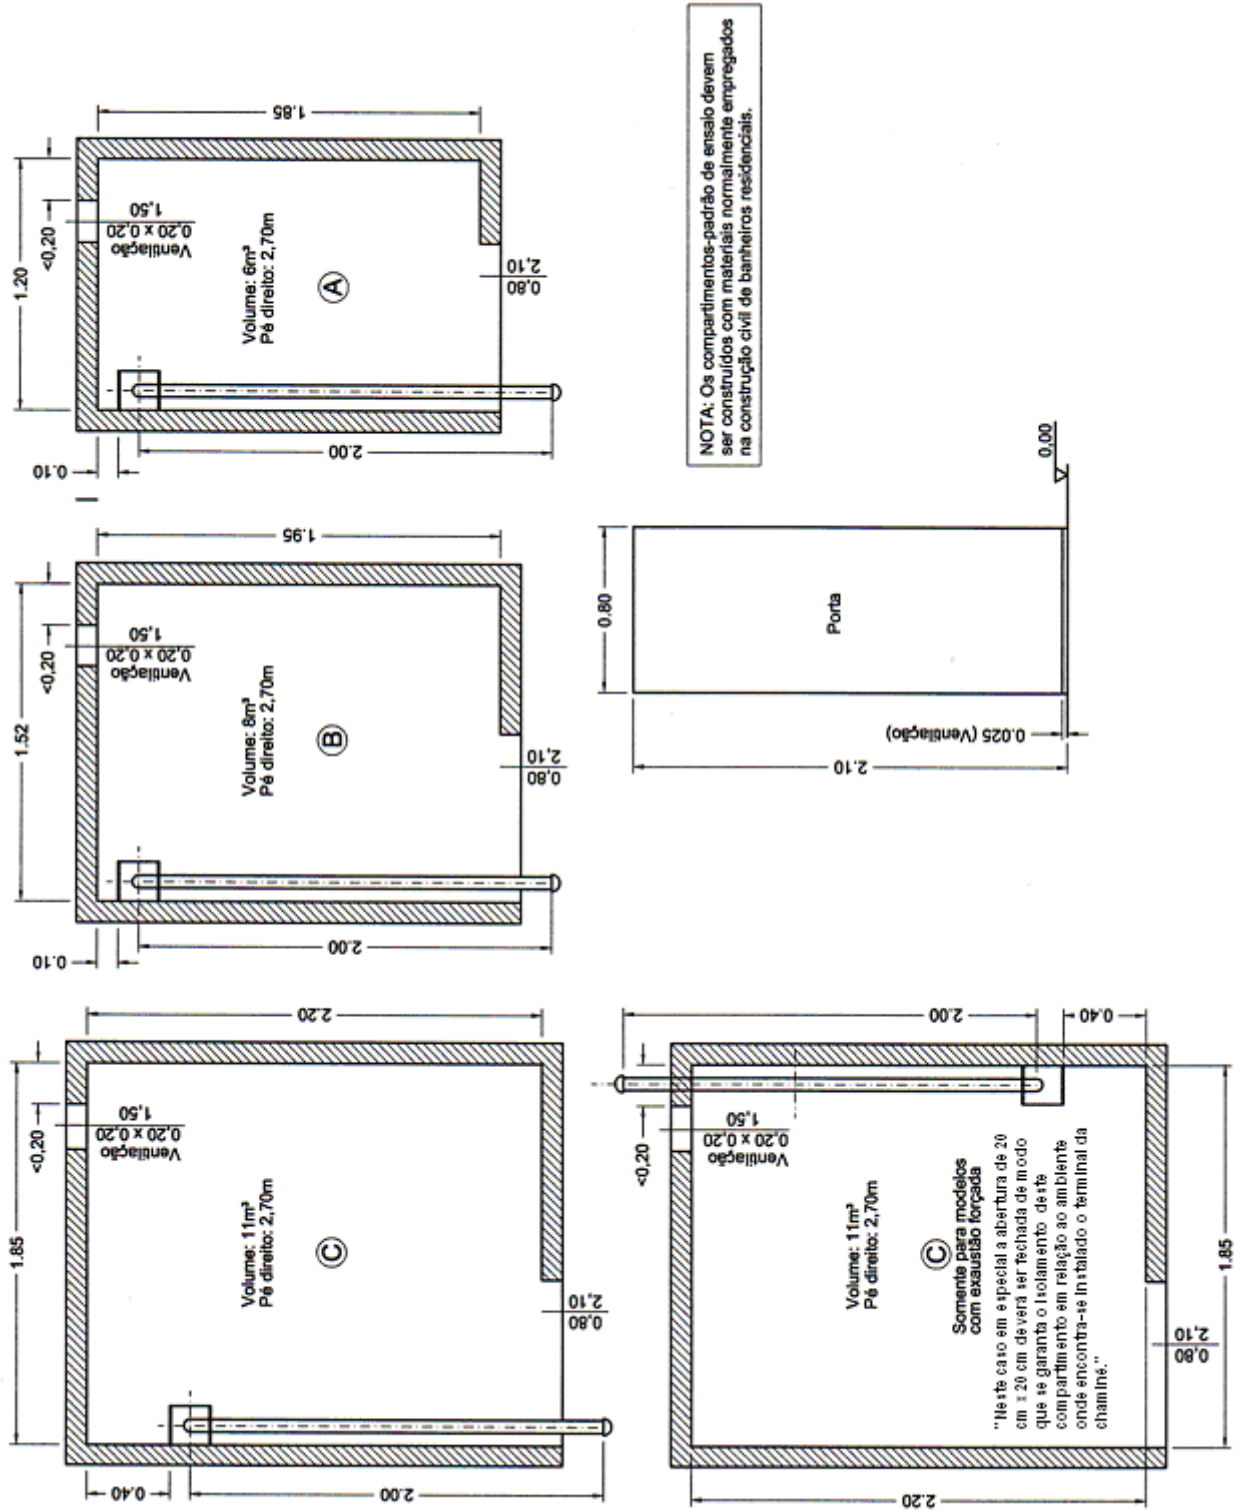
Abertura para ventilação e dimensões das salas de ensaio
